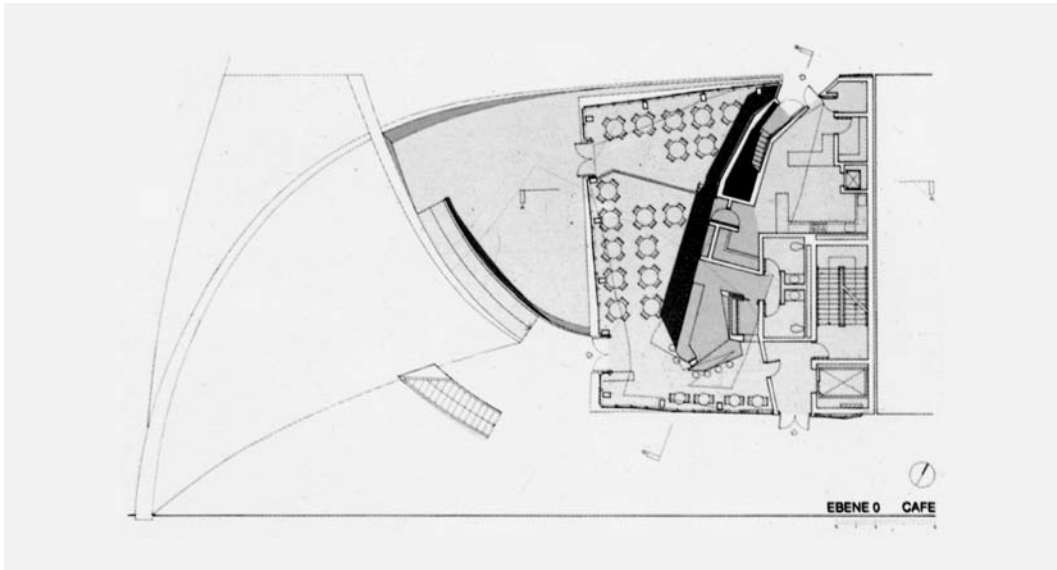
Peter Eisenman, Haus Immendorff, Düsseldorf, Deutschland, Entwurf 1993. Grundriss des Erdgeschosses.
